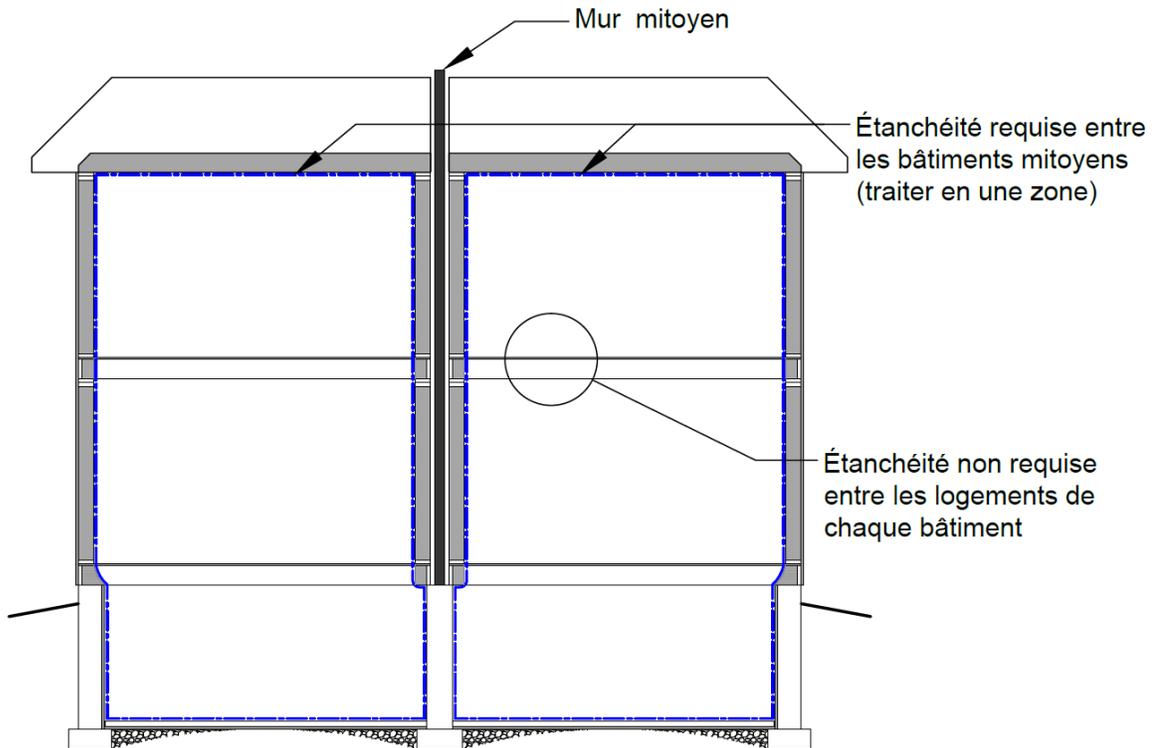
Étanchéité d'un mur mitoyen – Obturation et recouvrement complet de toutes les surfaces intérieures (art.2.2.2.6a)i) et b)ii))
